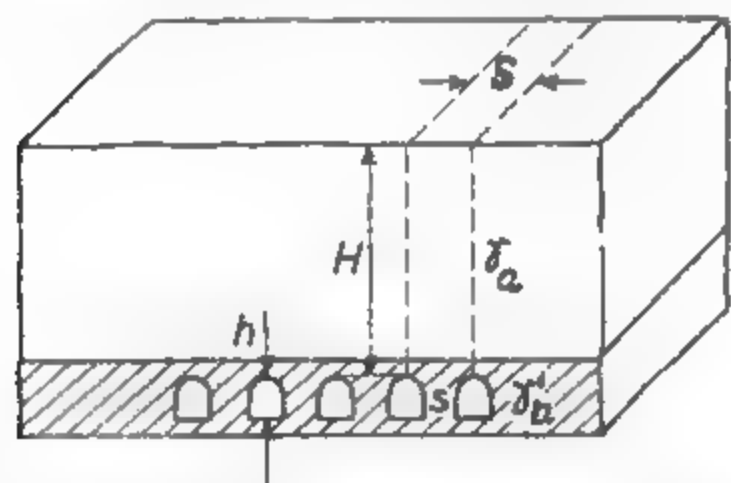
Schema cu elementele de calcul ale pilierilor de susținere (după L. D. Șeviaikov).
